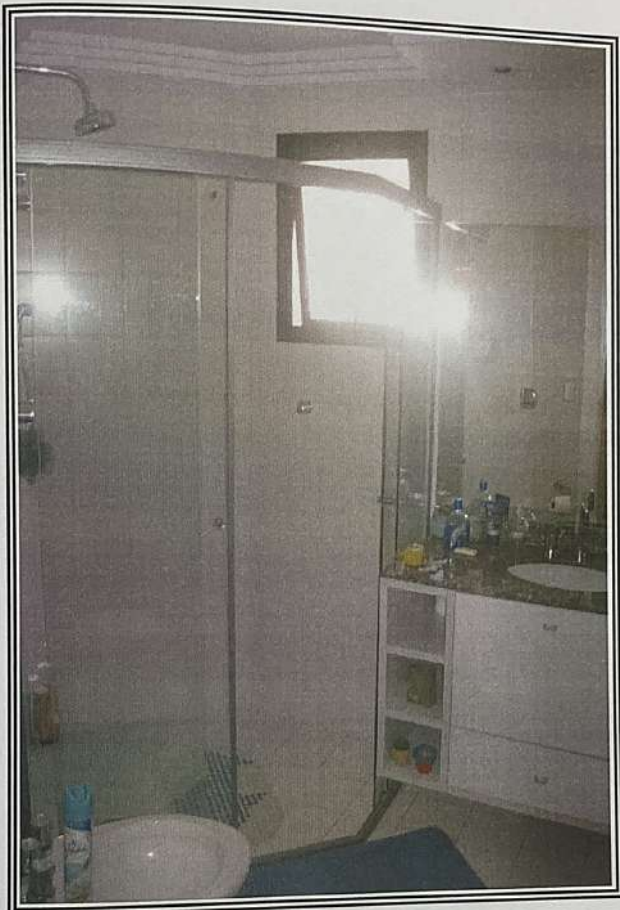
Vista do banheiro do dormitório 02 (suíte)
